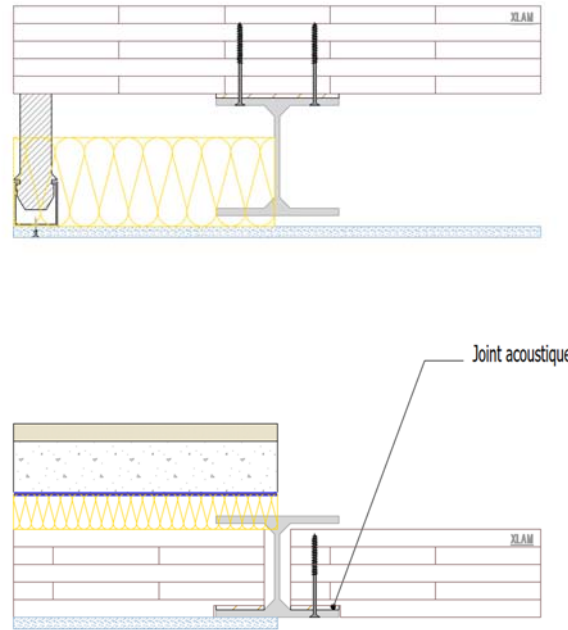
Jonction d'un plancher XLAM sur poutre métallique
